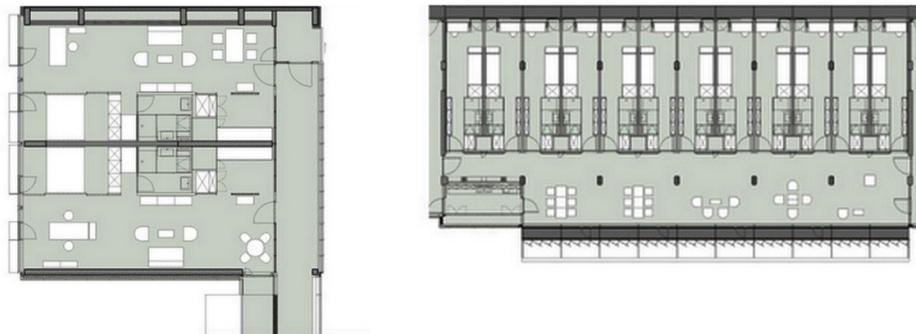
e 46: Plantas das tipologias de dormitórios. (Sustainable2010, 2010).
